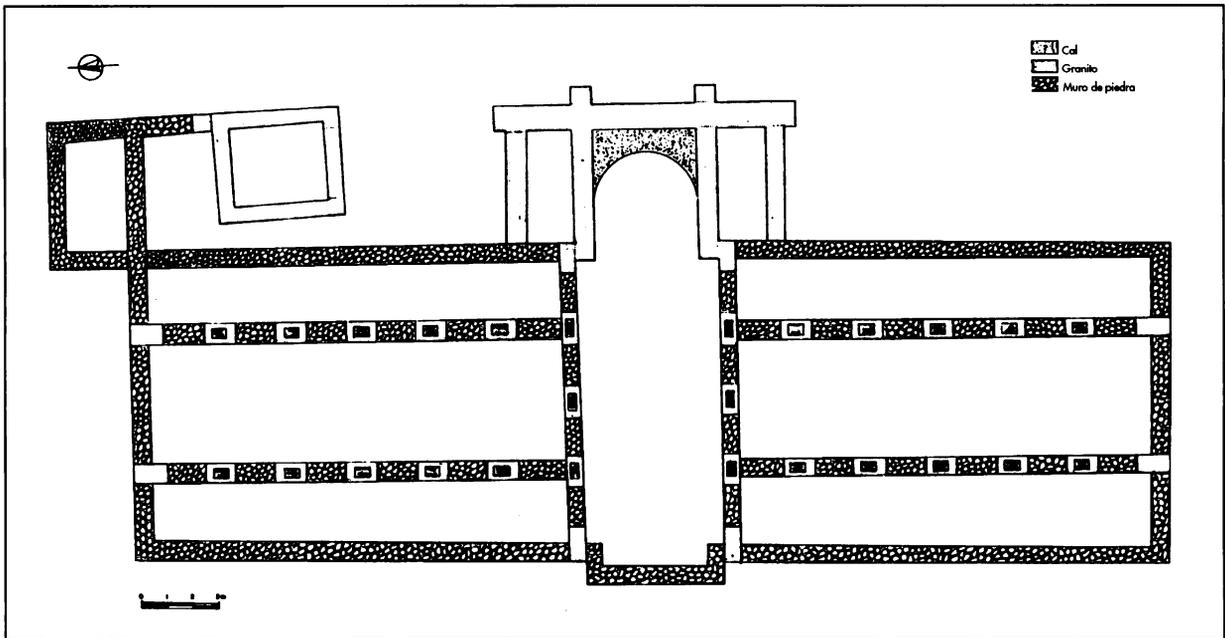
Reconstrucción de la planta del posible *xenodochium*.
